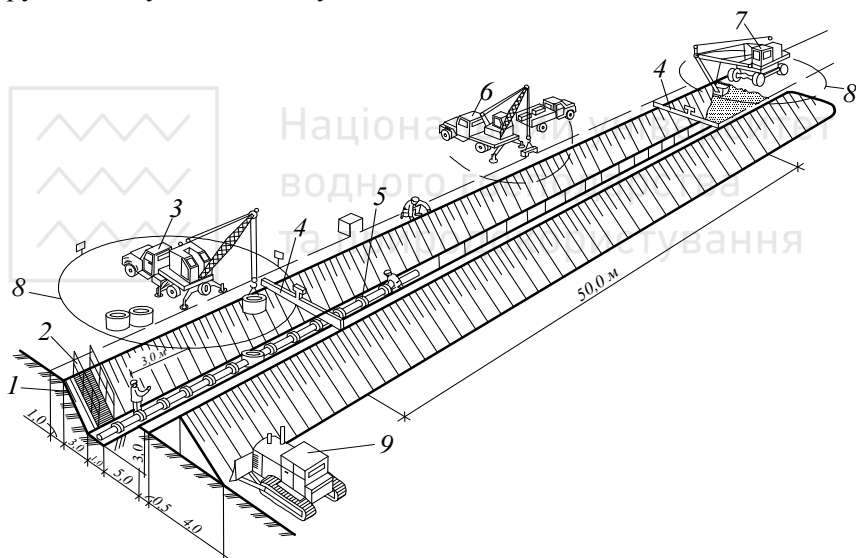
Схема організації будівельного майданчика при монтажі трубопроводу з керамічних труб:
